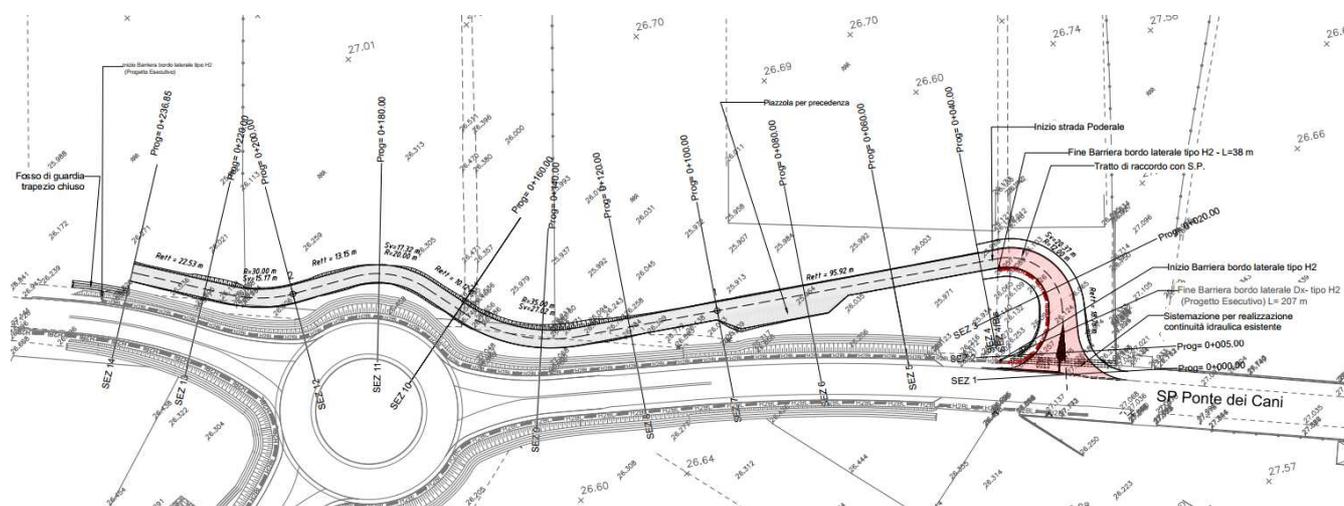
Stralcio planimetrico nuova viabilità agricola
